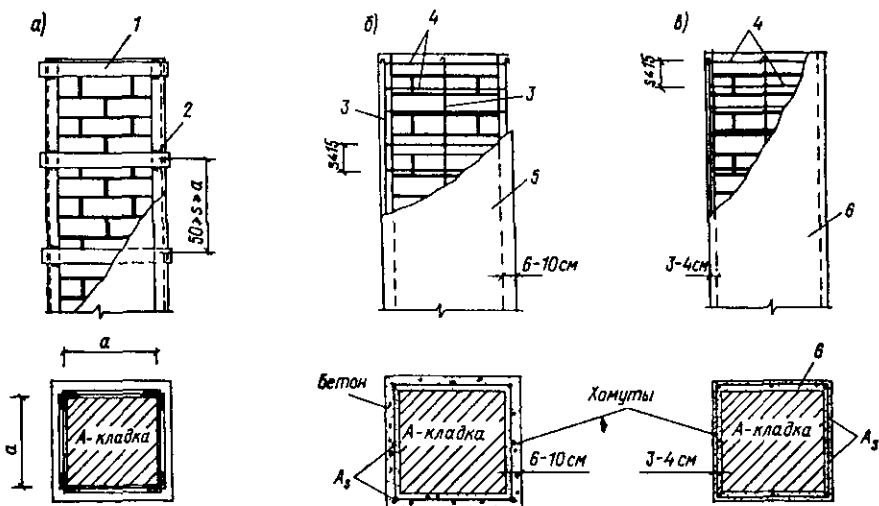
Схема усиления кирпичных столбов обоями а-металлической; б- железобетонной: в- армированной штукатуркой; 1-планка f_1 сечением 35 x 5 – 60 x 12 мм; 2- сварка; 3-стержни диаметром 5 ... 12 мм; 4-хомуты диаметром 4 ... 10 мм; 5- бетон класса В7,5 ... В15; 6- штукатурка (раствор марки 50 ... 100)
